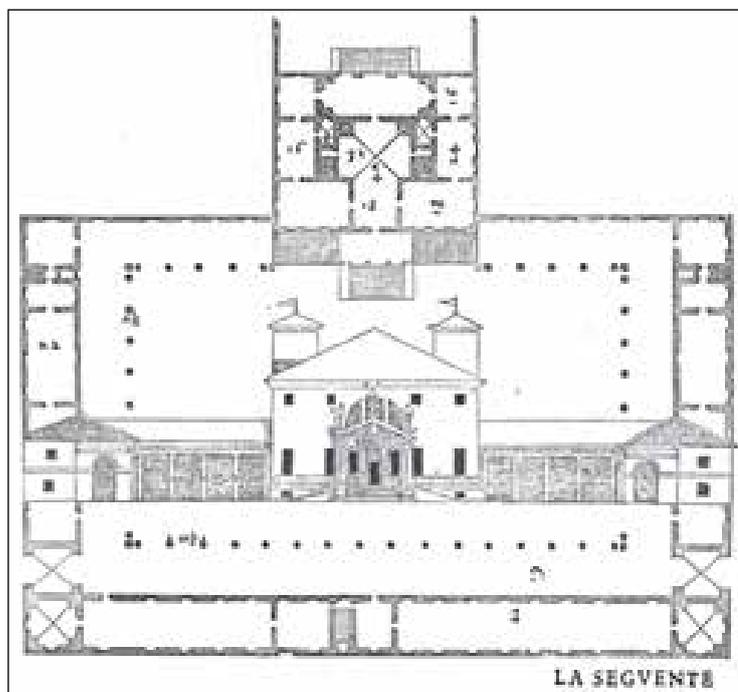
Planta e fachada da Villa Pisani registrada no Il Quattro Libri dell'Architettura. Fonte: PALLADIO, 2002.
